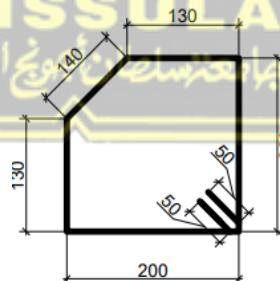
Bar bending dinding saluran panjang 1 m (c)
